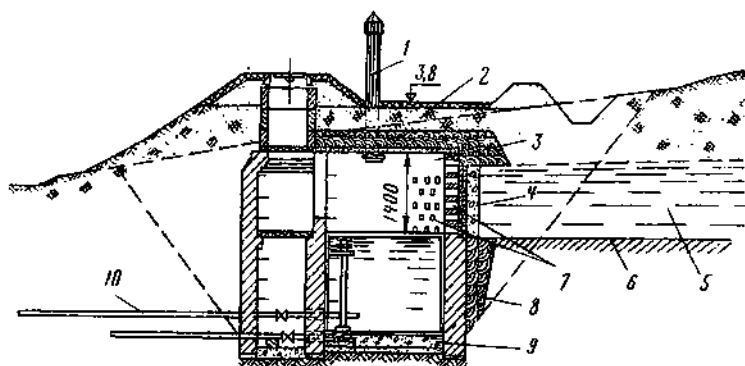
Железобетонная каптажная камера нисходящего ключа
